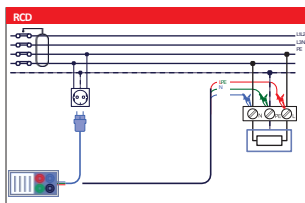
Schema di collegamento tensione di contatto (RCD - U_b)
